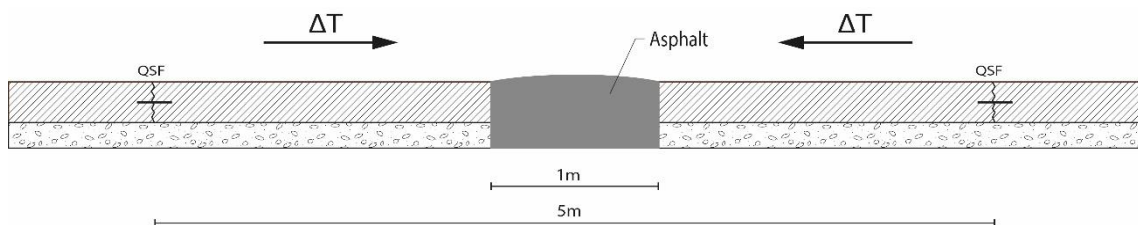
Betondecke mit/ohne Verbund zur HGT erwärmt sich und verformt den Asphalt (Kuppenbildung)
